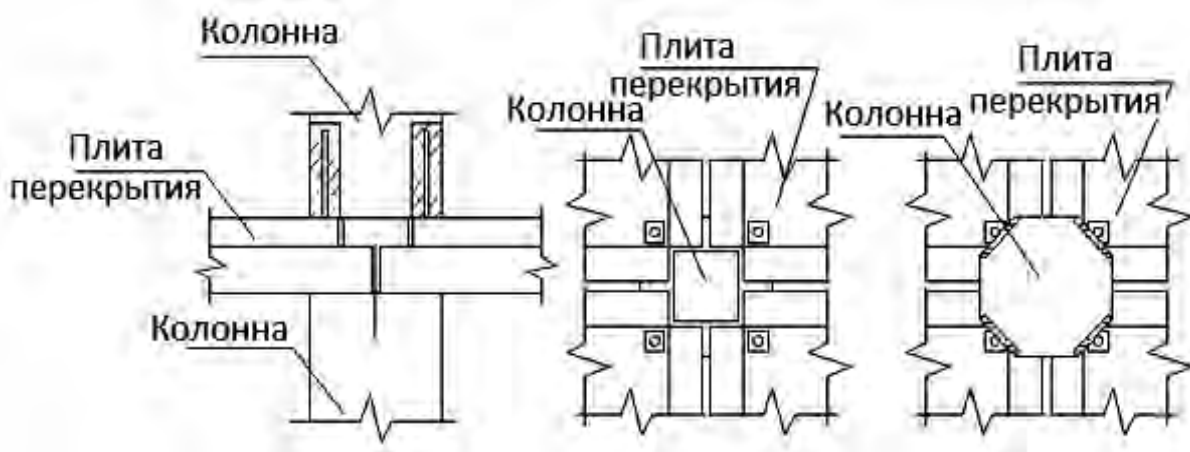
Узел сопряжения колонн с колоннами и плитами перекрытия
